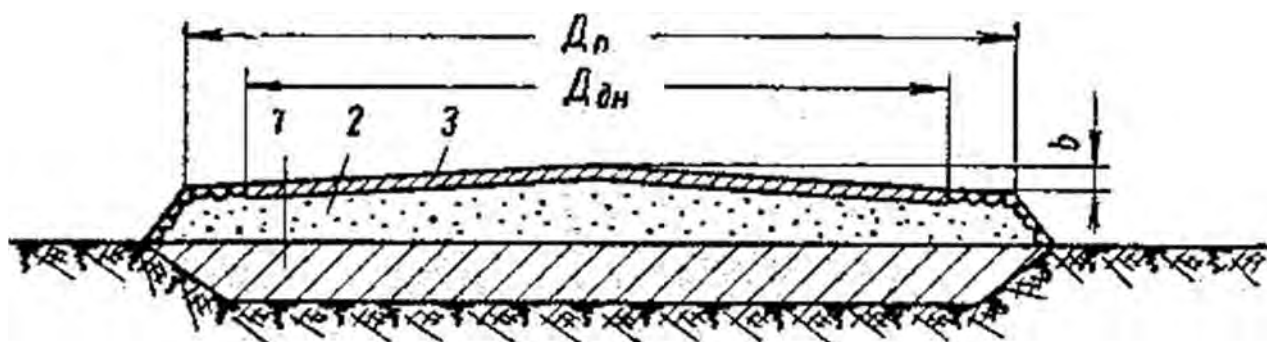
Основание под вертикальный цилиндрический резервуар: 1 – насыпной грунт; 2 – песчаная подушка; 3 – изоляционный слой из супесчаного грунта, смешанного с жидким битумом или каменноугольным дегтем
